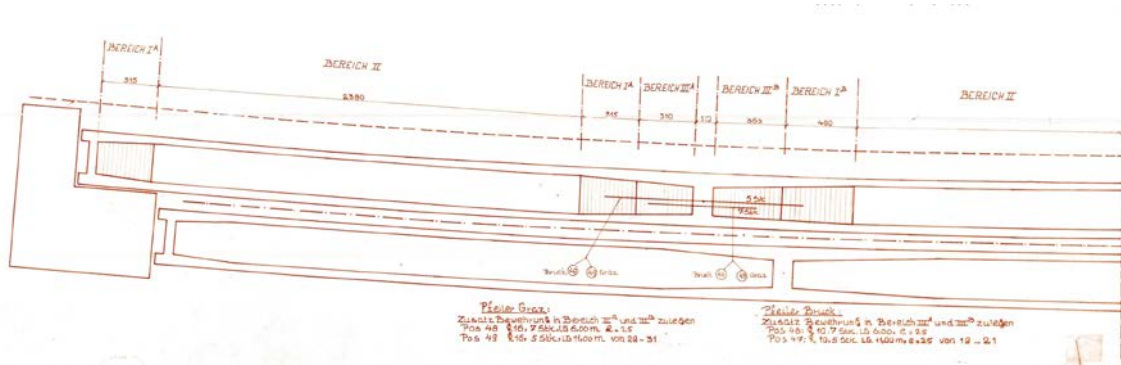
Grundriss Bewehrungsplan
